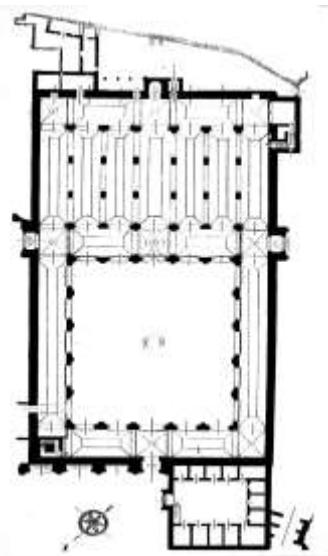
مسقط أفقى للجامع الجديد بتارودانت
